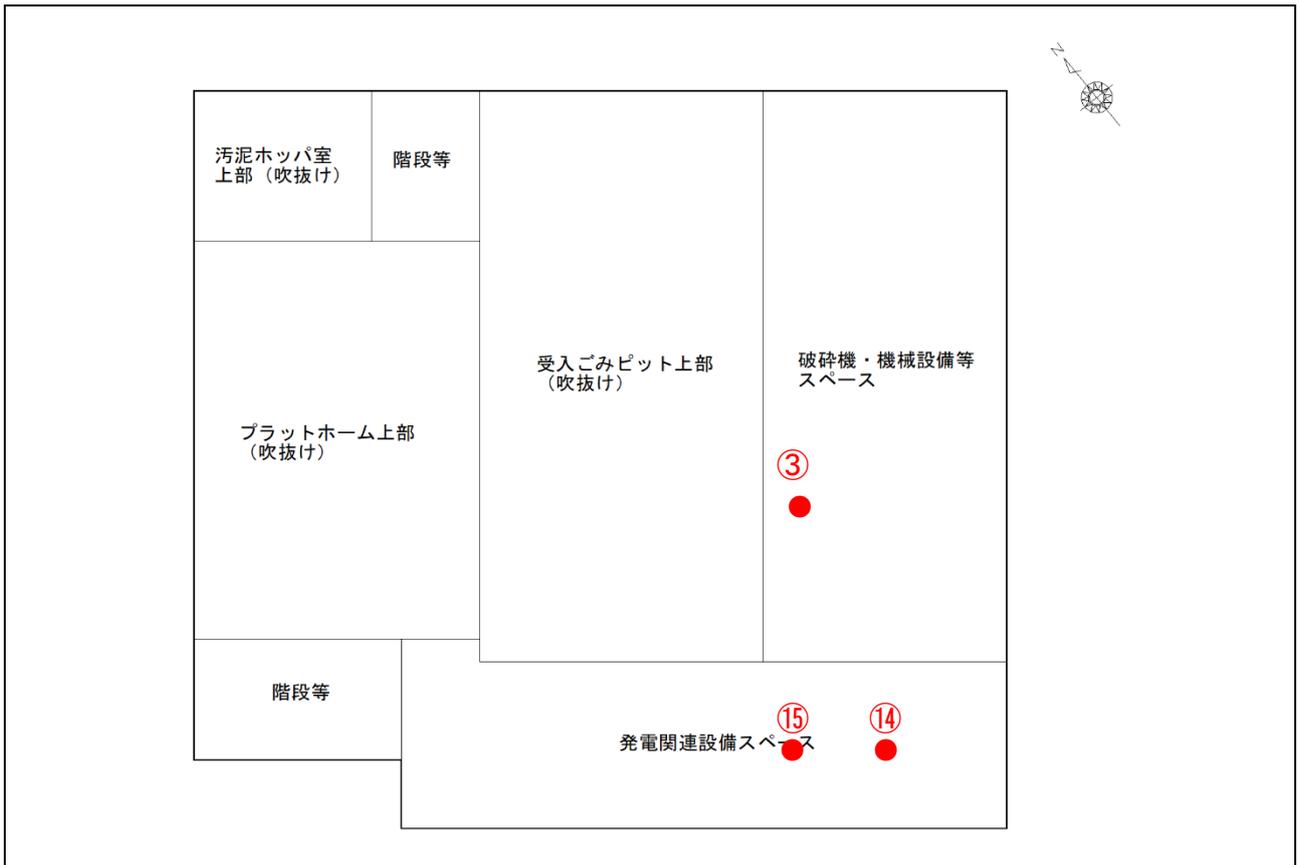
(3) 廃棄物受入棟平面図 (2 階)
